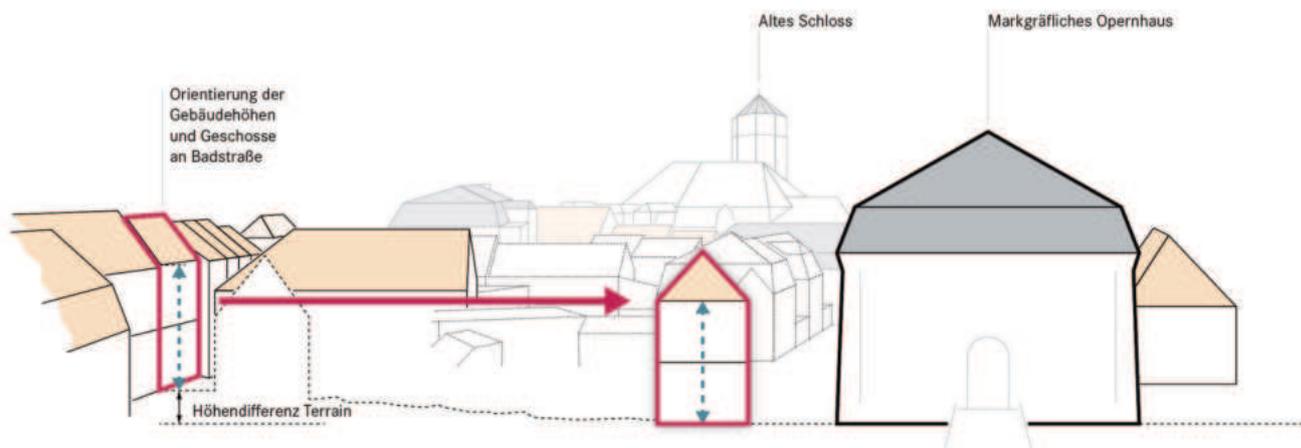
Schema Stufe 1: Gebäudehöhen Badstraße
